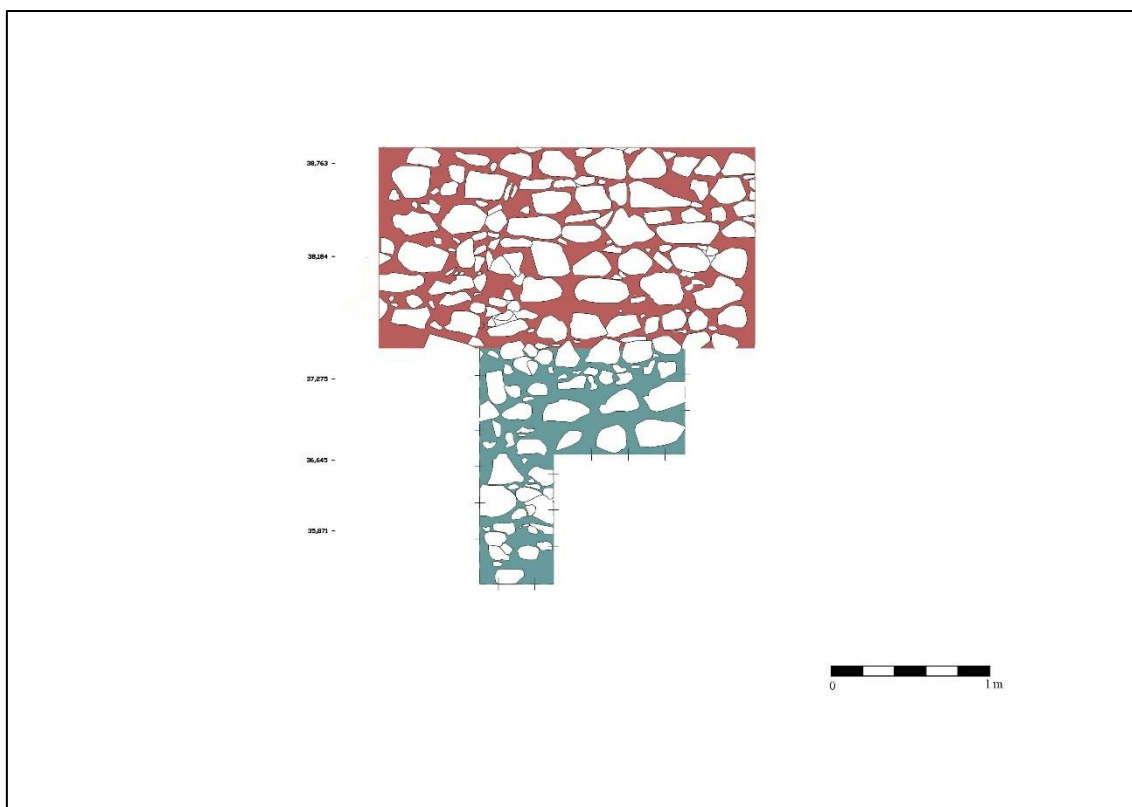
Sondagem 5 (azul). Alçado da Muralha Nascente. Crédito Rui Santos.
